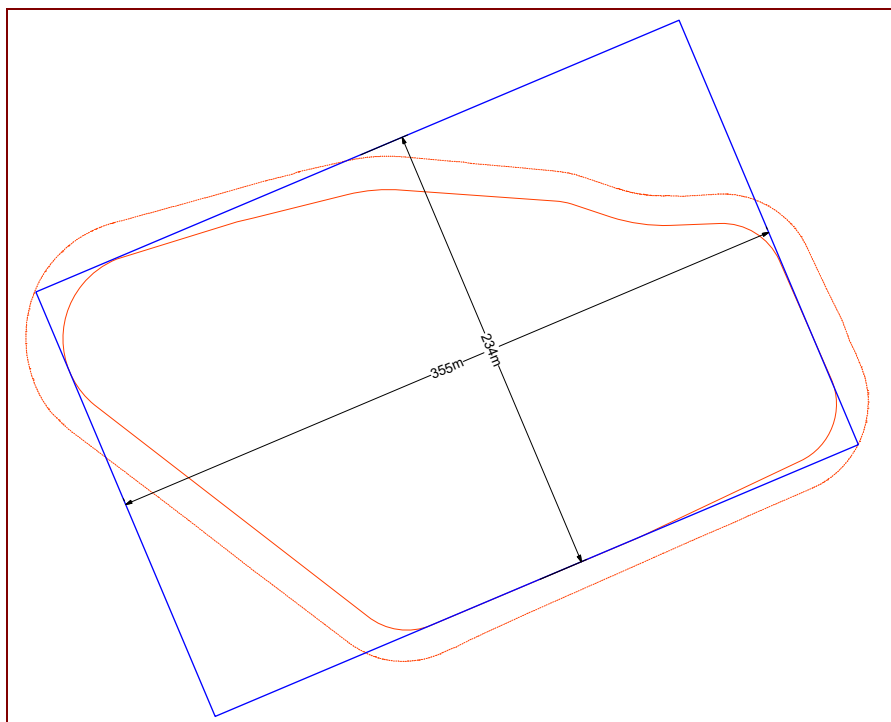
PLATEA 1 (rettangolo con dimensioni L e B massime del fondo discarica)
